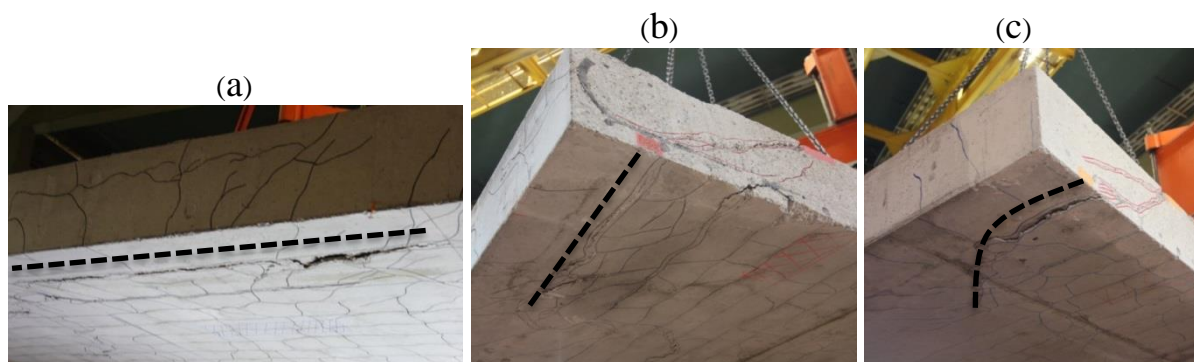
Modes de rupture des dalles de la série VI ; mise en relief des allures de largeurs effectives en cisaillement (ligne de macrofissure à proximité de l'appui) : (a) Dalle S2, (b) Dalle S9 et (c) Dalle S10
